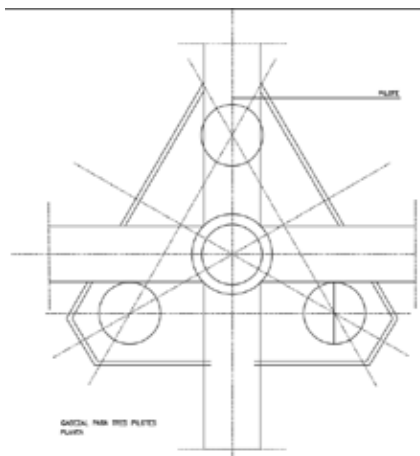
Detalle de Cabezal para tres Pilotes (Planta), fuente: La Autora (2017).
